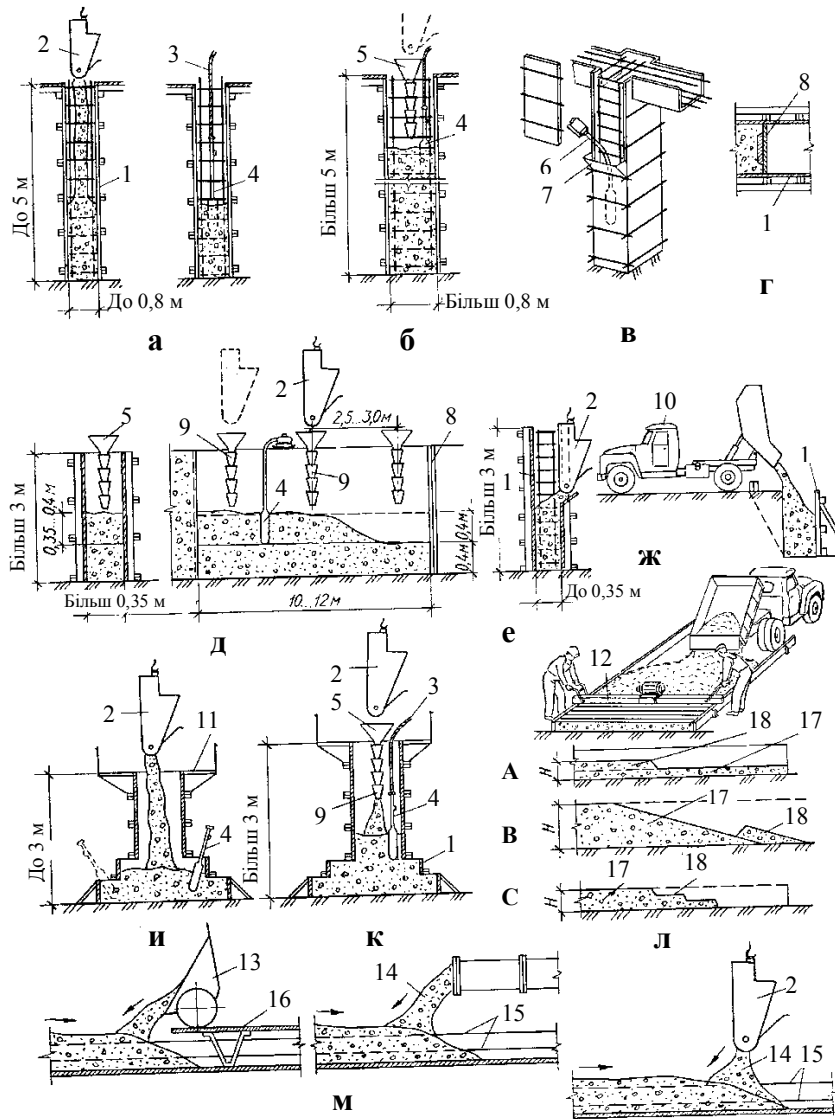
Схеми бетонування: а – колони до 5 м заввишки; б – колони більше 5 м заввишки; в – колони в разі густої арматури балок; г – установлення щита розподільної опалубки; д – товстої стіни; е – густоармованої тонкої стіни; ж – підпірної стіни; и – східчастого фундаменту до 3 м заввишки; к – те саме, більше 3 м заввишки; л – плити по ґрунту (А – горизонтальними шарами; В – похилими шарами; С – ступенями); м – плити для підготовки; 1 – опалубка; 2 – цебер; 3 – мотузка; 4 – глибинний вібратор; 5 – лійка хобота; 6 – вібратор з гнучким валом; 7 – кишень; 8 – розподільний щит; 9 – хобот; 10 – автобетоновоз; 11 – підмости; 12 – вібробрус; 13 – тачка; 14 – бетонна суміш; 15 – арматура; 16 – качальний хід; 17 – покладений шар бетону; 18 – укладення шару бетонної суміші
